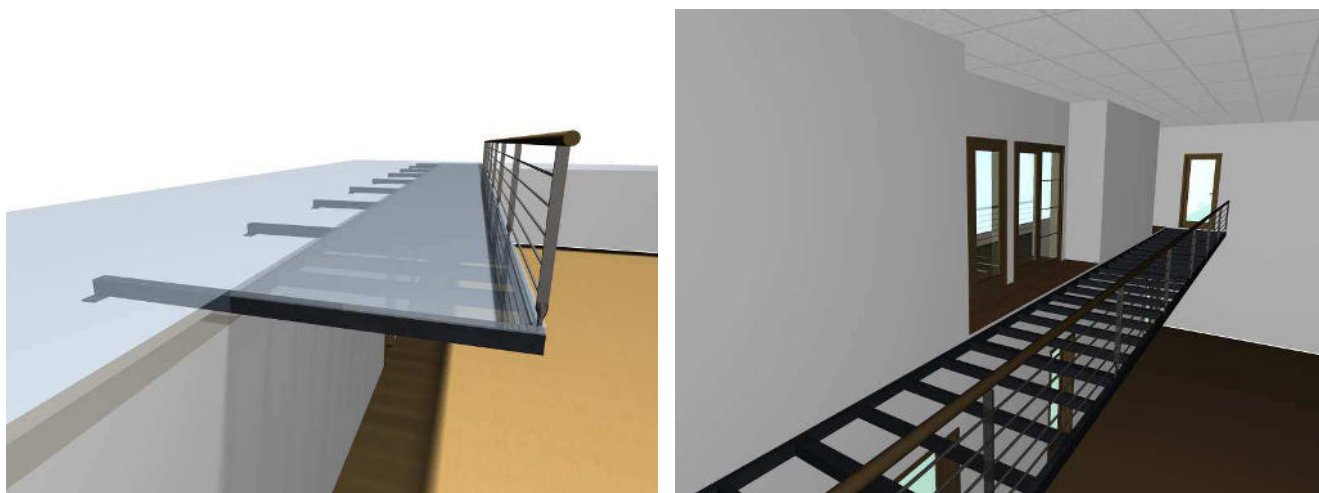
Vistas 3D, da estrutura do passadiço / varanda – “Ninho de empresas”
